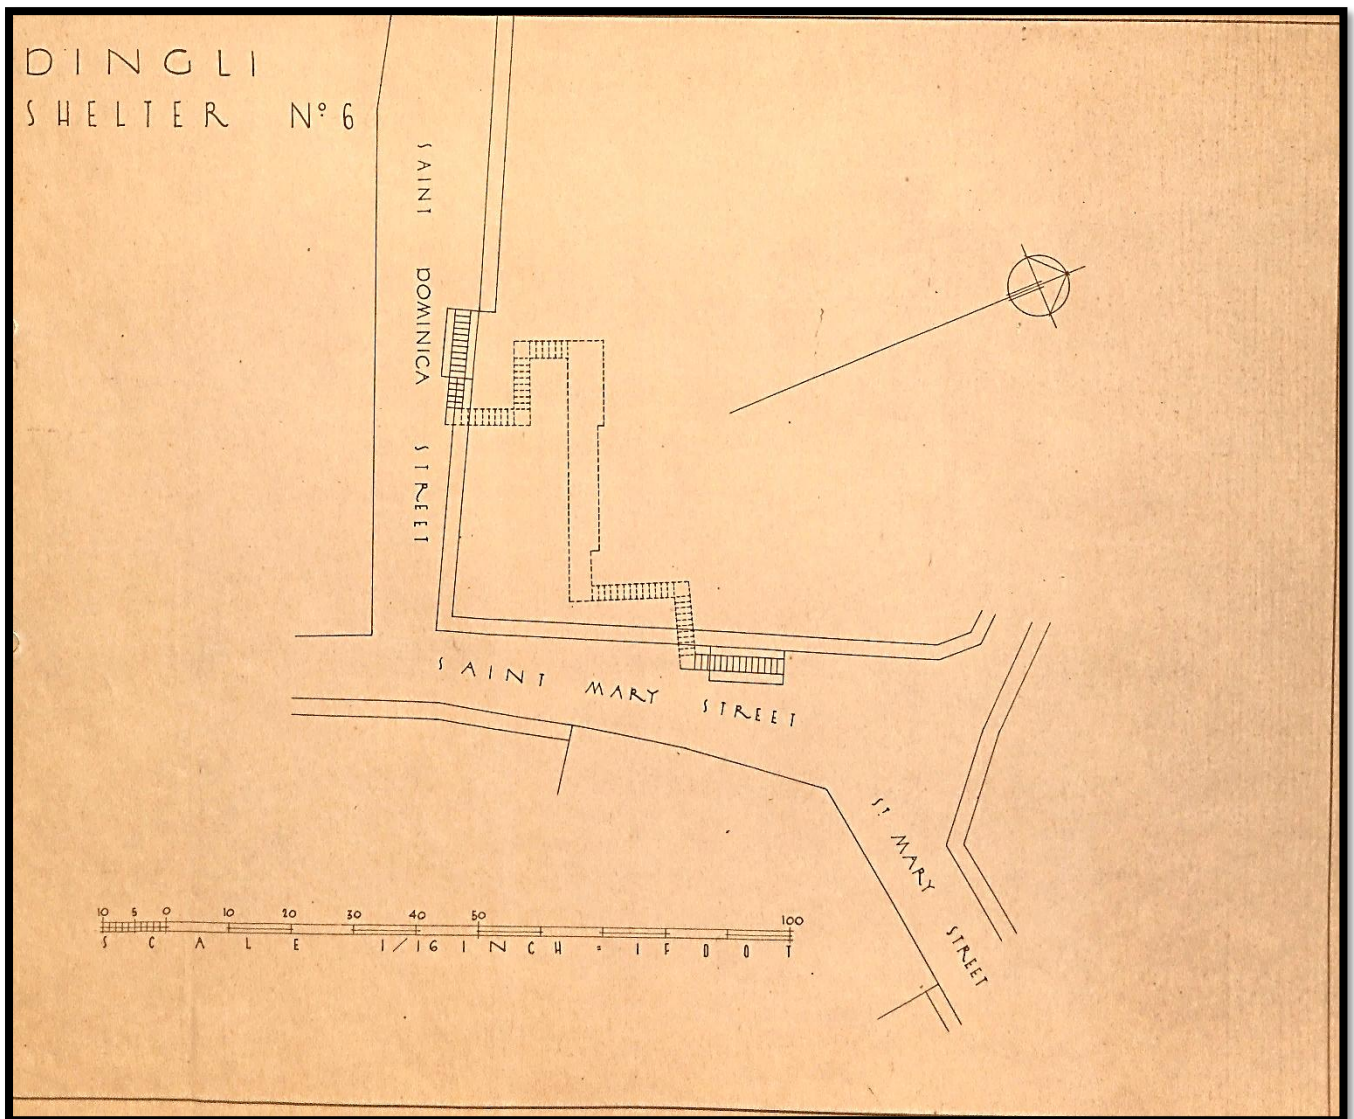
Planta do Abrigo nº6 "Saint Dominicana Street – Saint Mary Street."
